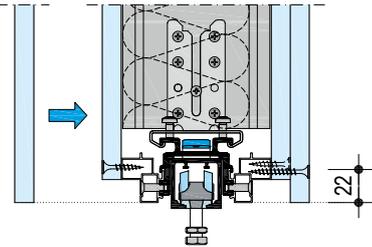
2. Beplankungslage montieren – Sturzbereich bei CW 100 Profilen
